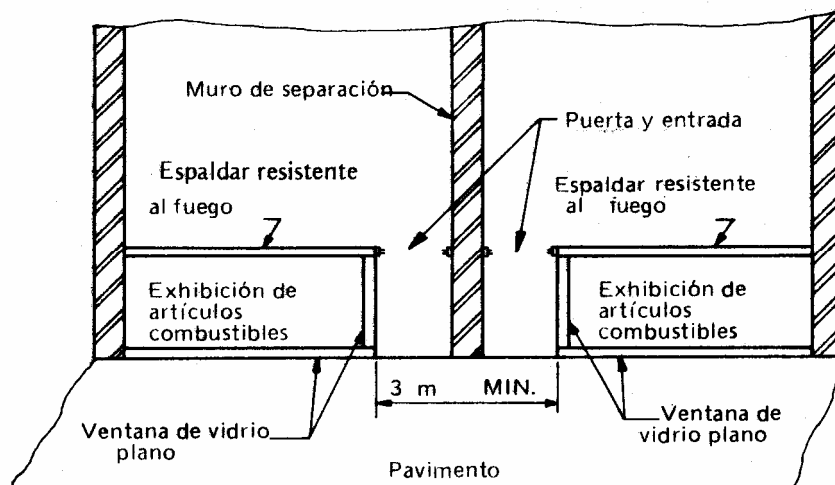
Planta Típica de vitrinas de exhibición para tiendas.
